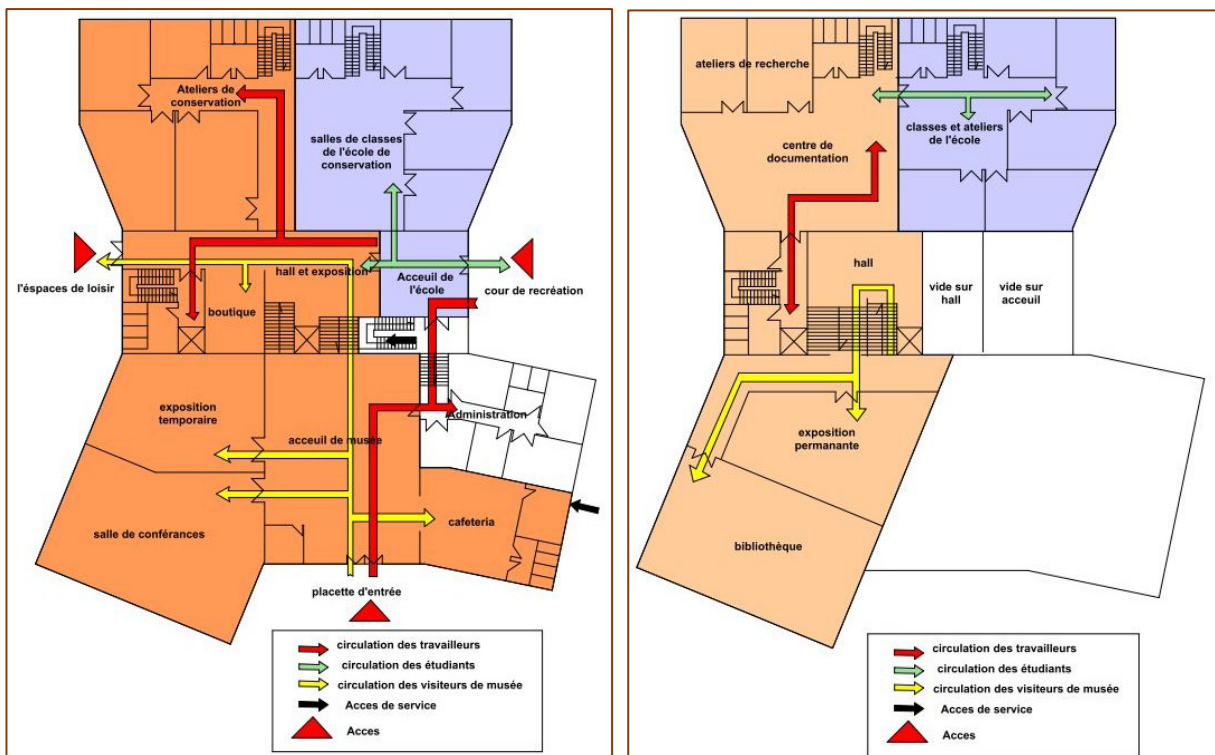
plan schématique de RDC du projet (l'auteur). Figure 97 plan schématique R+1 du projet (l'auteur).
